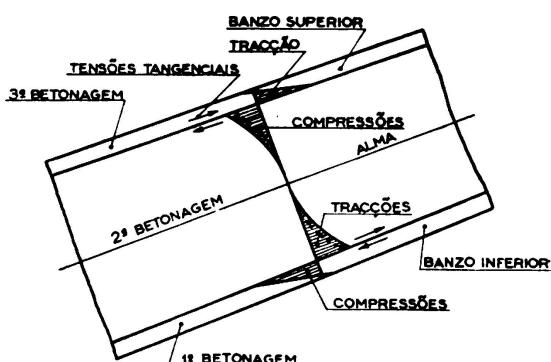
Tensões devidas à contracção diferencial num arco betonado por anéis
